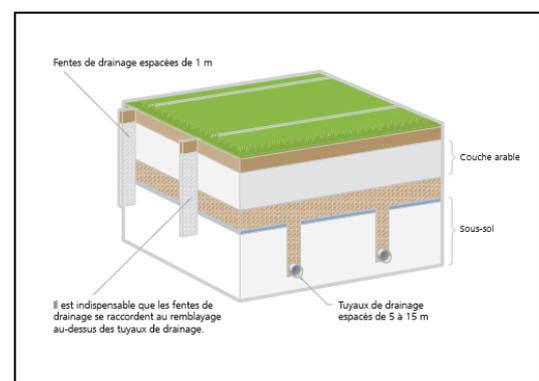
drainage de l'eau vers la terre au-dessus de la couche de drainage dans un terrain de jeu³
